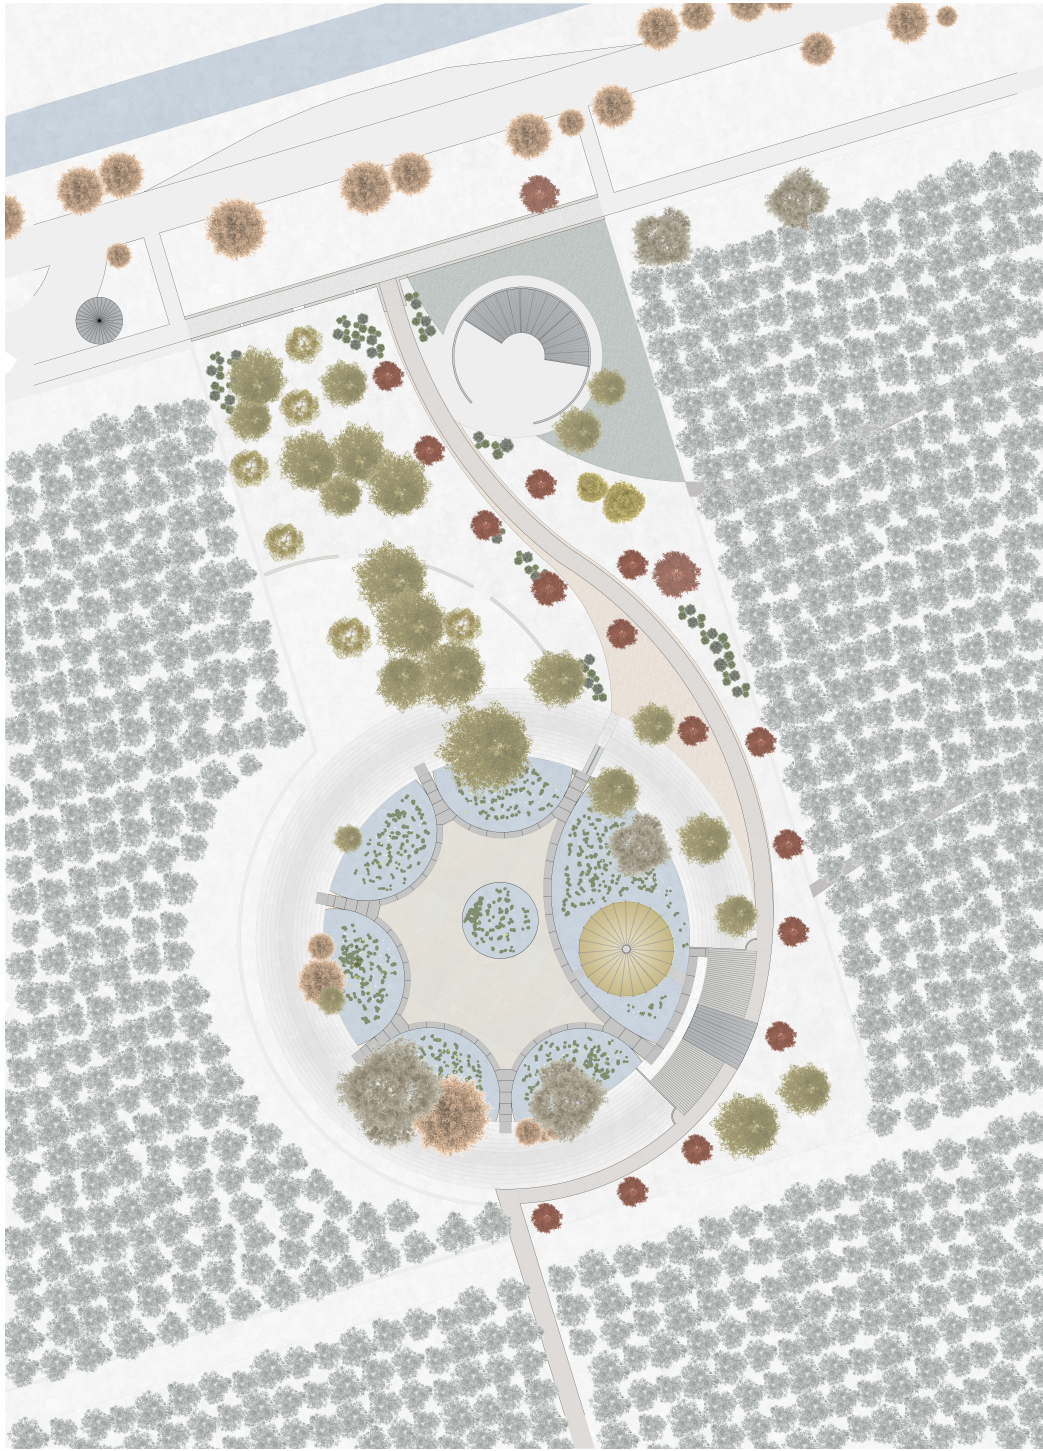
Visione autunnale della pianta di progetto (EdA)
